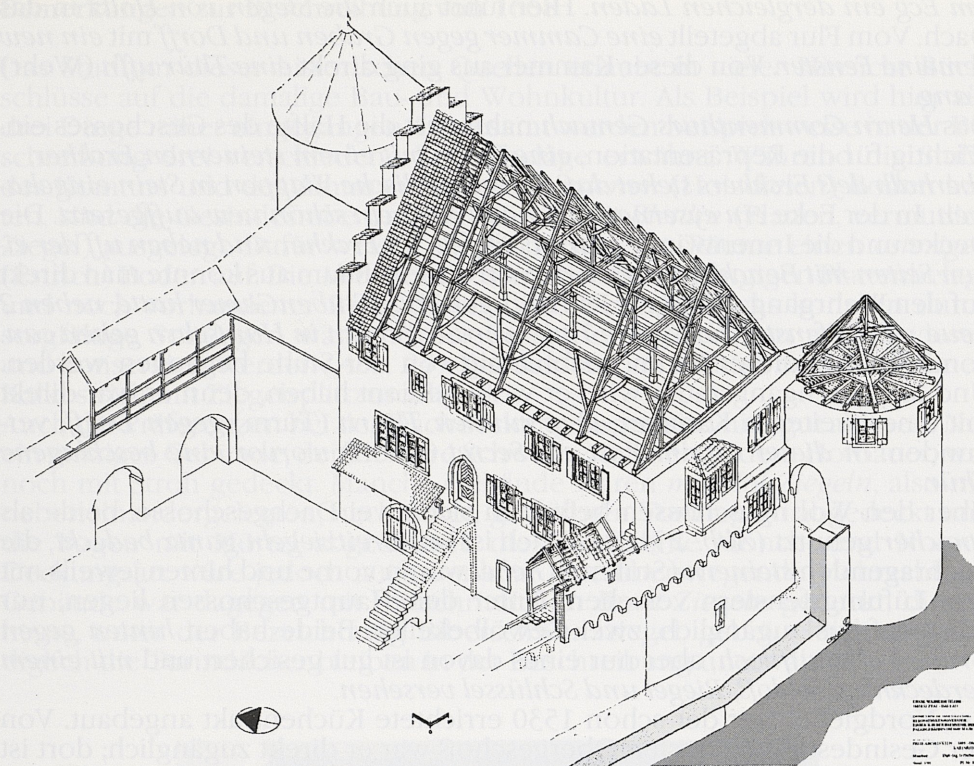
Schloß Dallau, Palas der Wasserburg. Einblick in den Dachstuhl als Rekonstruktionsversuch um 1570. Der Dachstuhl wurde im Gegensatz zu den um 1438/39 errichteten Hauptgeschossen erst im Jahre 1451 abgezimmert. Das erste Dachgeschoß war als liegende Stuhlkonstruktion errichtet. Die Kopfstreben waren über den liegenden Stuhl und den Spannriegel überblattet und an die Sparren und Kehlbalken angeblattet. Erst nachträglich wurde eine Mittellängsunterstützung mit profilierten Stützen eingebaut. Die zweite Dachebene war als stehender Stuhl mit Steigbändern als Queraussteifung errichtet. Der archivalischen Überlieferung zufolge war das Dach mit sog. Breitziegeln gedeckt, Vorläufer der heutigen Biberschwanzziegel.
